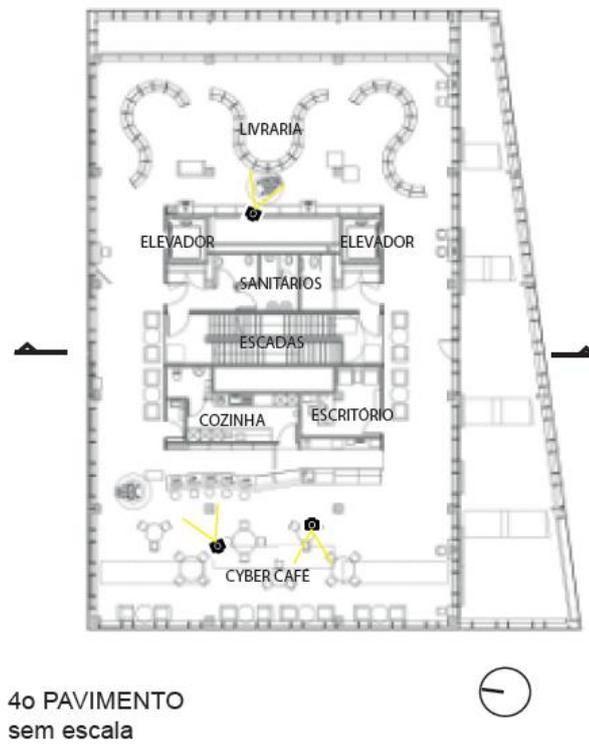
Planta do Quarto e Último Pavimento da *Idea Store Whitechapel* (LI, 2013)
